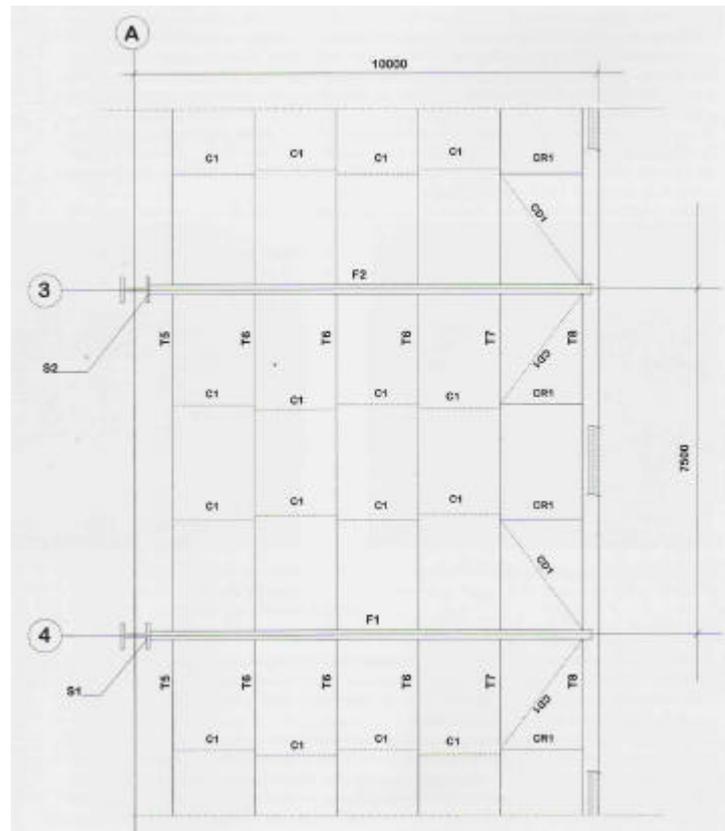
Planta marquise metálica: projeto de montagem.
